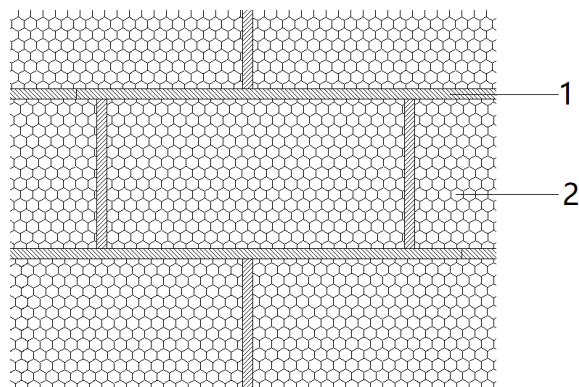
敷面 EPS 板防火分隔条分仓构造示意图
